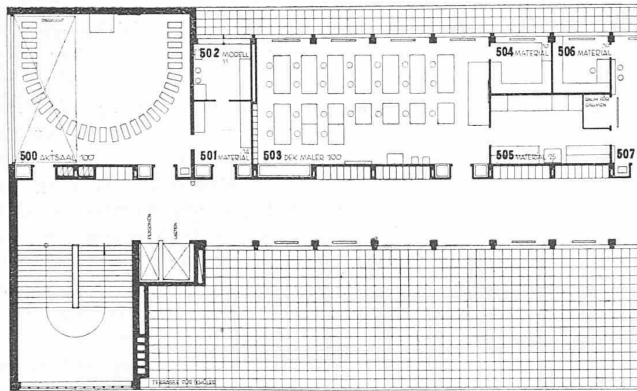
Teilgrundriss vom Dachgeschoss der Schule.
